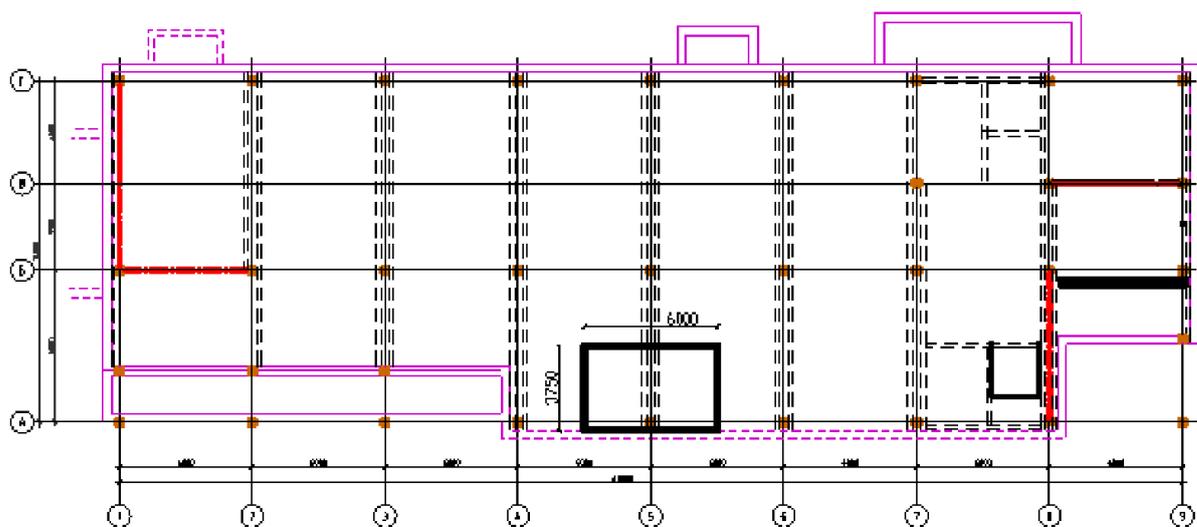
Грузовые площади фундамента на отм. 0,000 по оси А-5.
